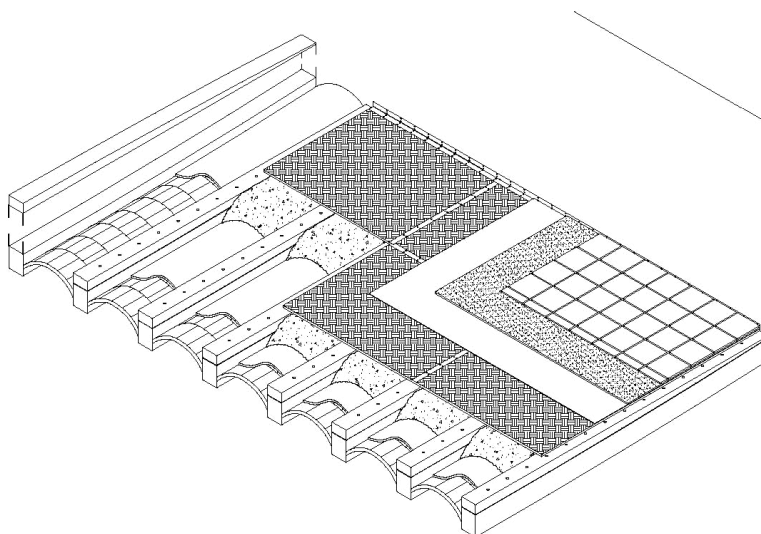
Esquema de la restauración de un forjado. Fuente: Propia.
